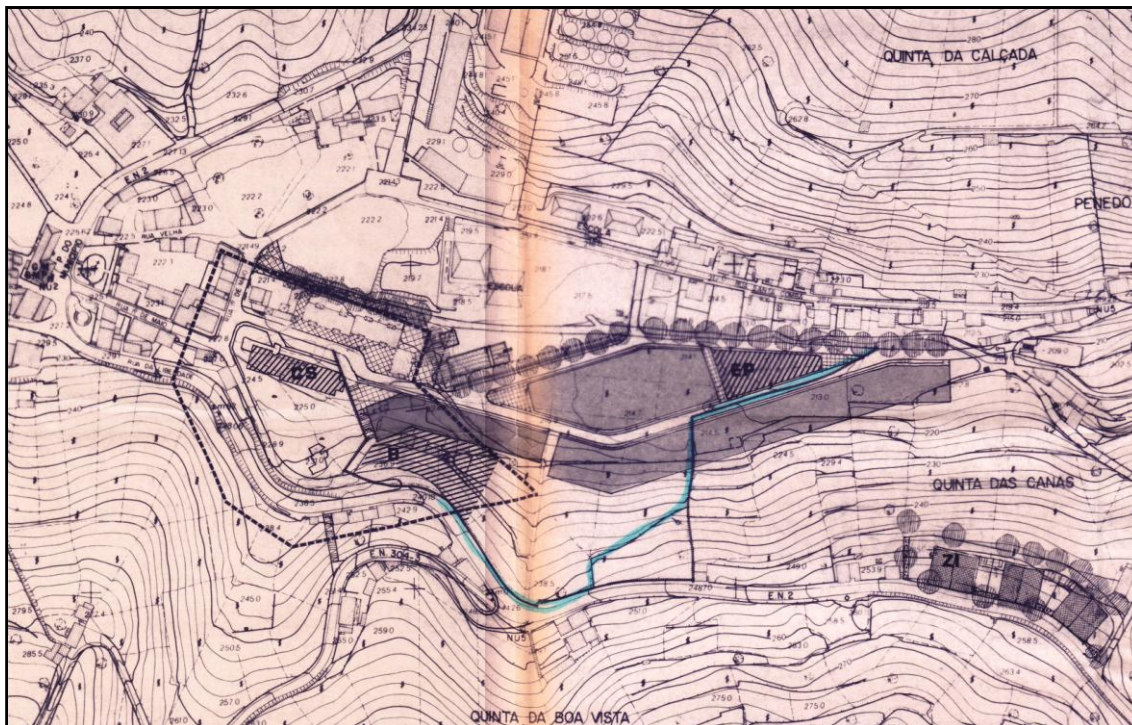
Planta de estudo. Plano de Pormenor da Quinta das Canas (1988)
